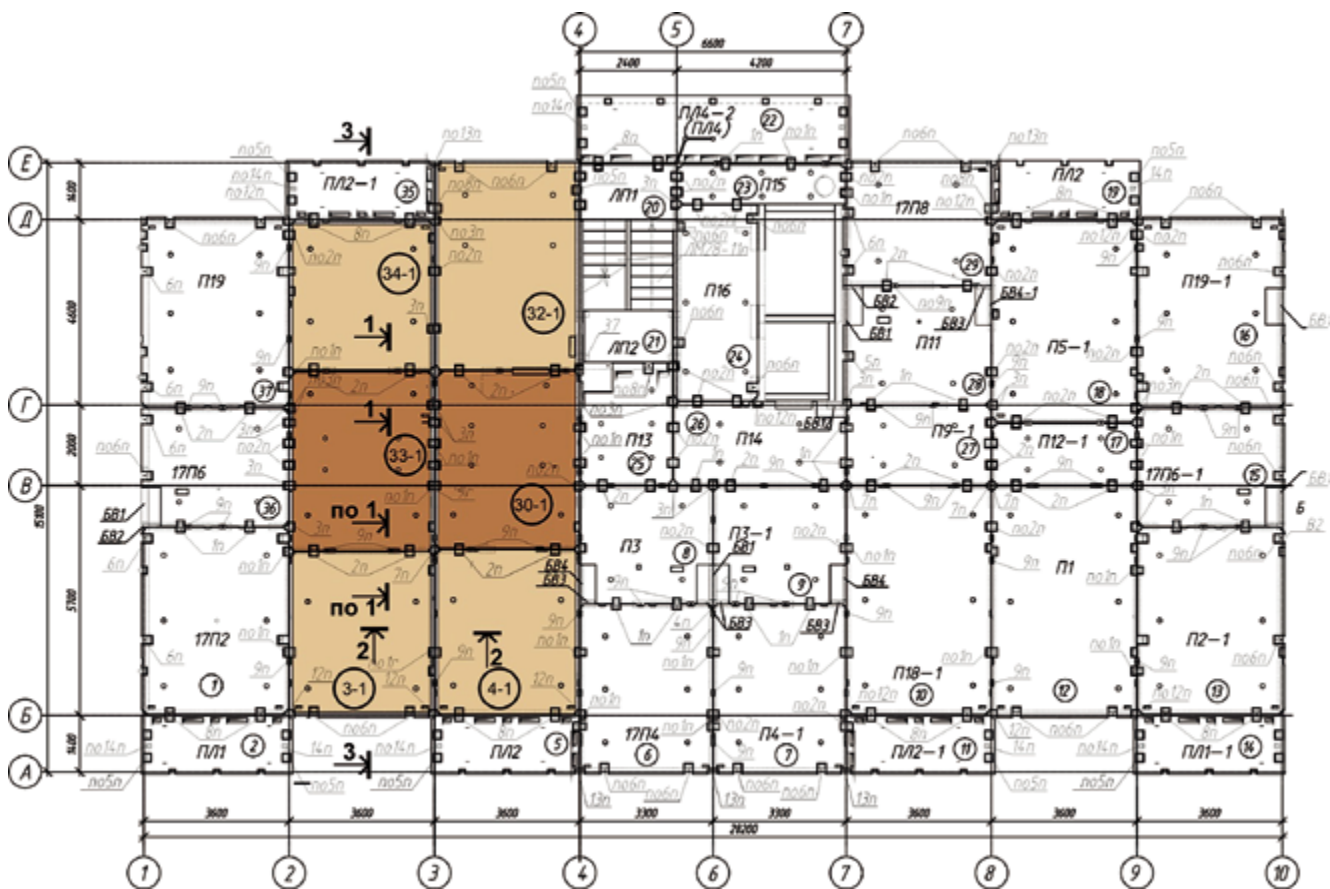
Монтажная схема плит перекрытий типовой блок-секции с многопролетными неразрезными сборно-моноконтными поперечными перекрытиями в осях 2-3 и 3-4 (широкий шаг)
